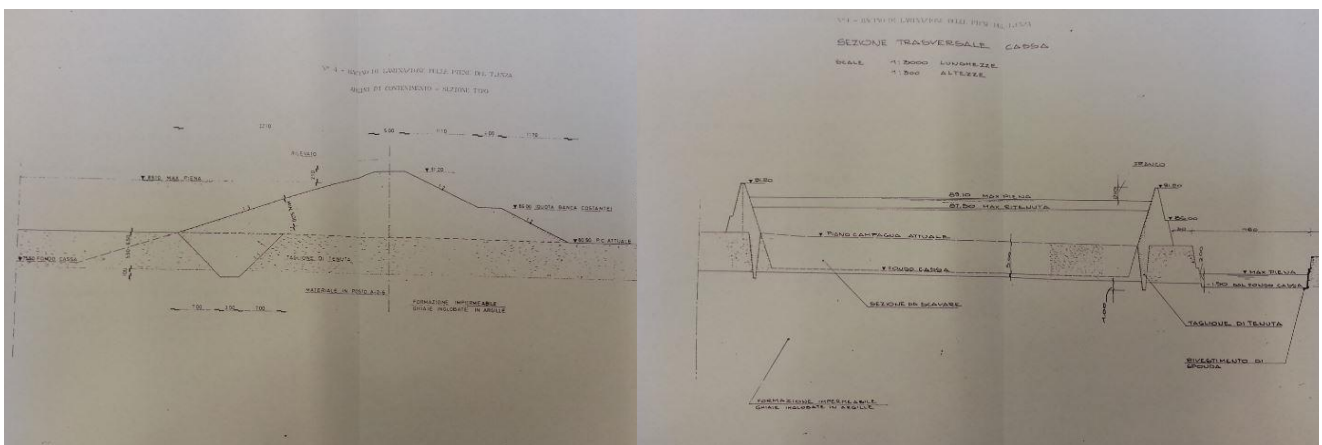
Sinistra: Argini di contenimento (sezione tipo); destra: Sezione trasversale cassa di espansione.
